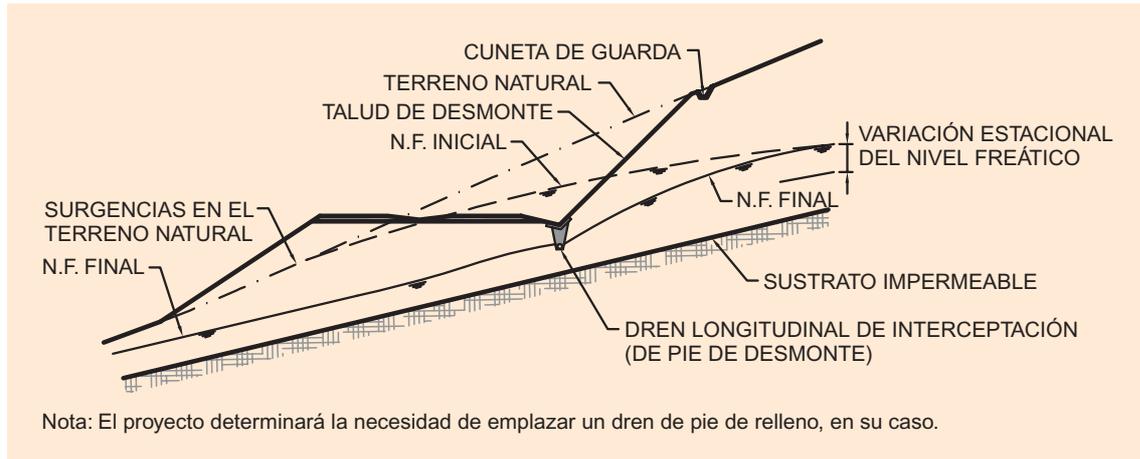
EJEMPLO DE DREN LONGITUDINAL DE INTERCEPTACIÓN
